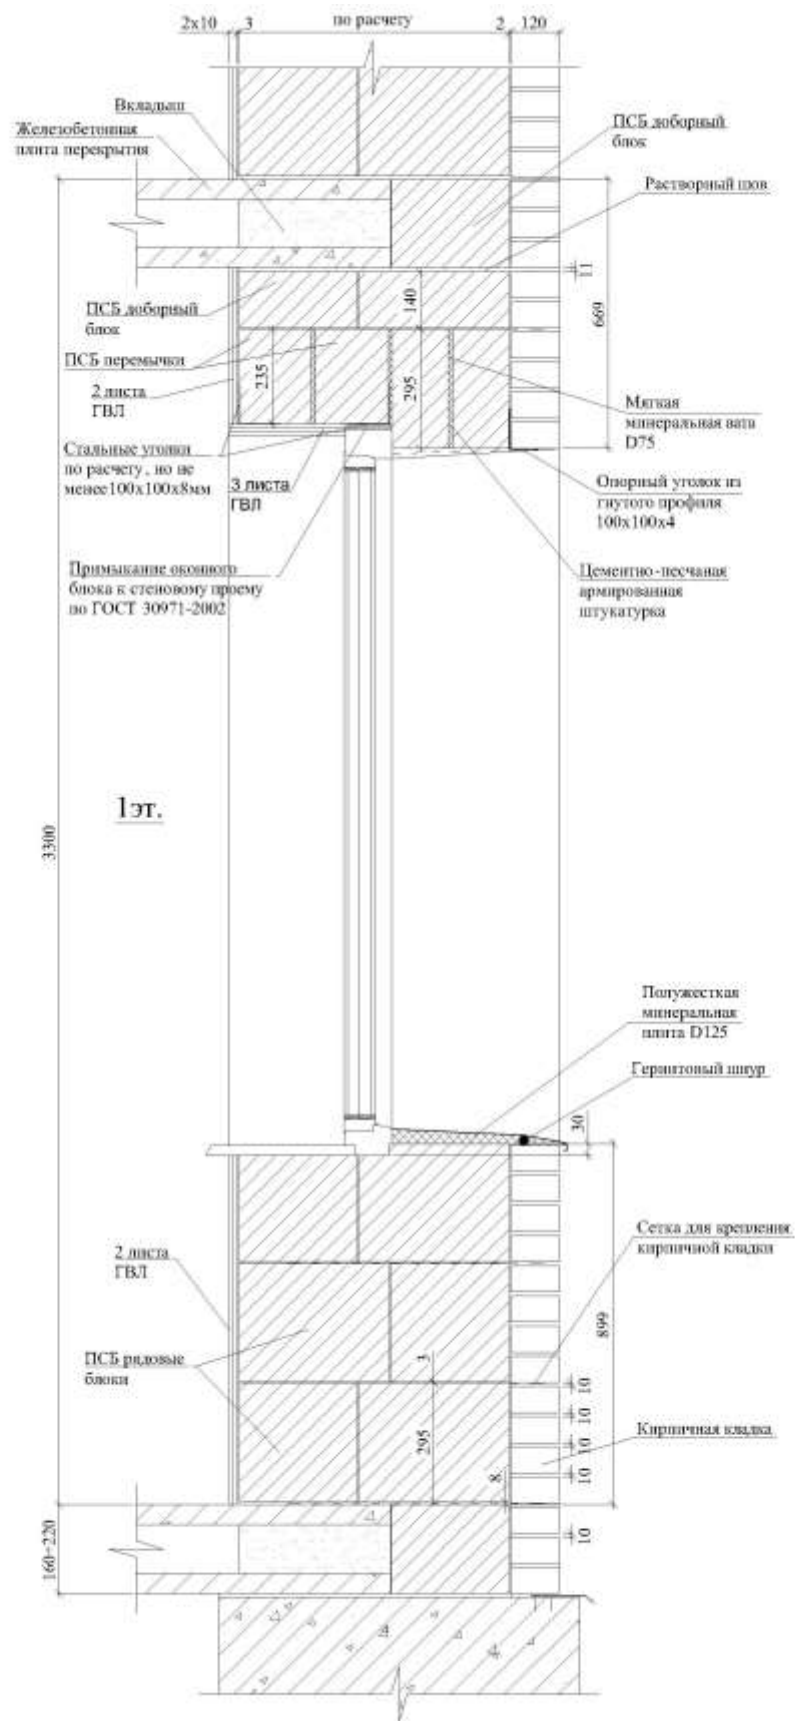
Несущая стена из полистиролбетонных блоков с фасадной облицовкой толщиной в 0,5 кирпича. Вертикальный разрез по оконному проему
